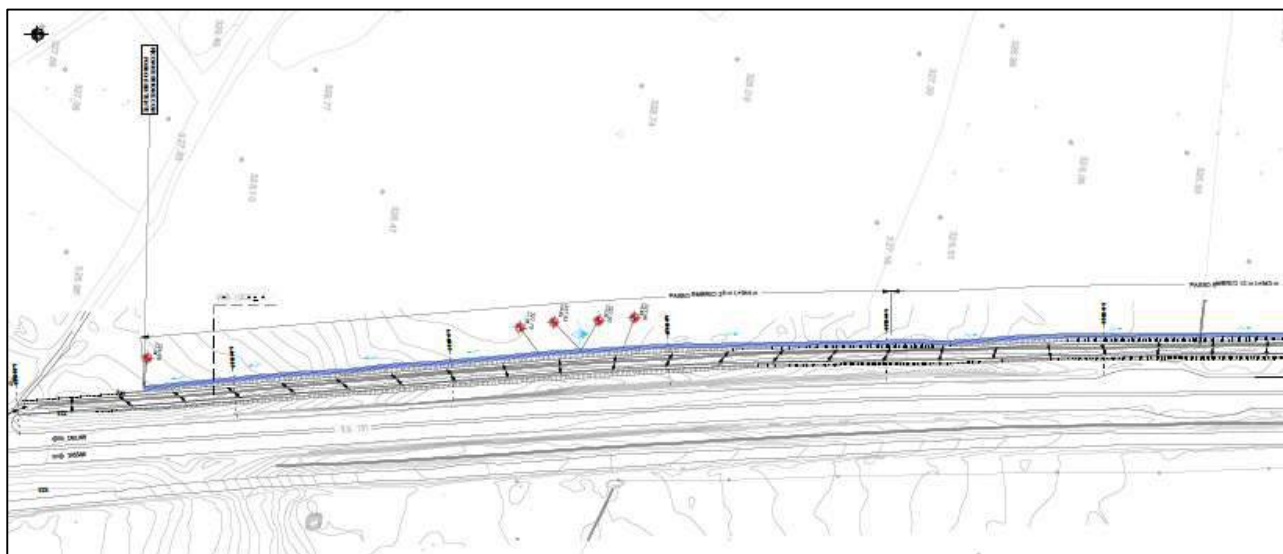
Stralcio planimetrico intervento S21-Risoluzione accessi al km 127+000, inquadramento 1/2
